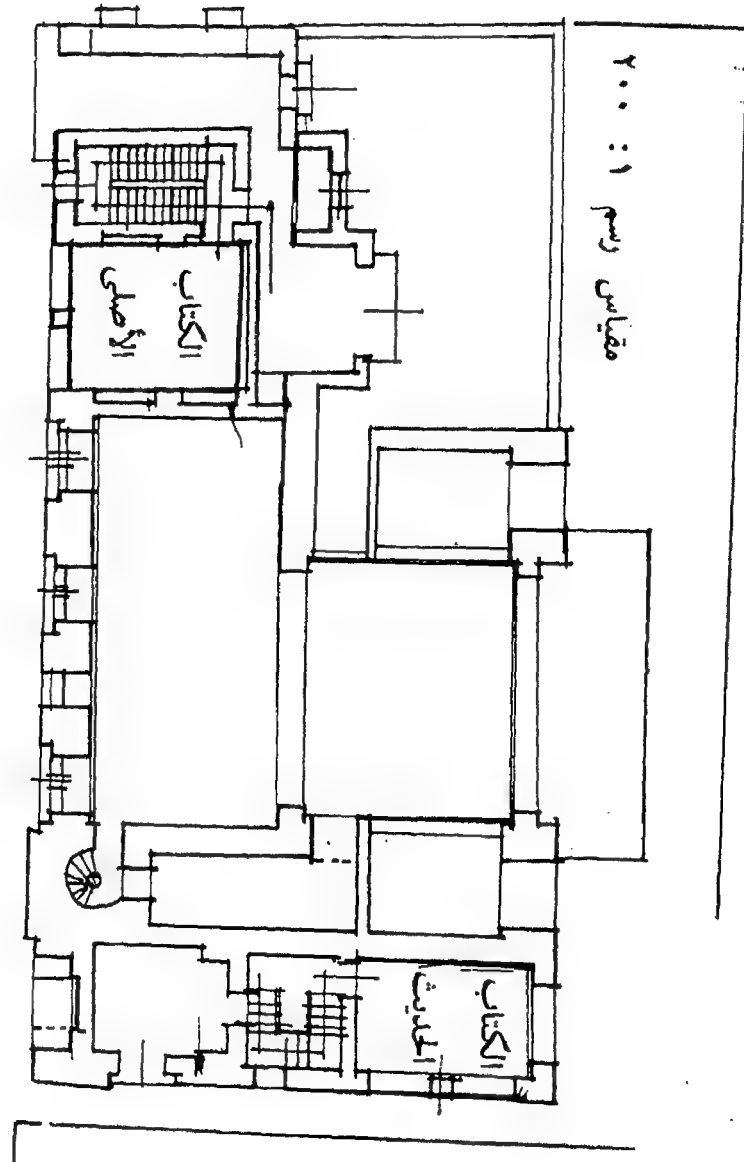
مسقط أفقى لجامع يوسف أغا الحين بميدان باب الخلق.
